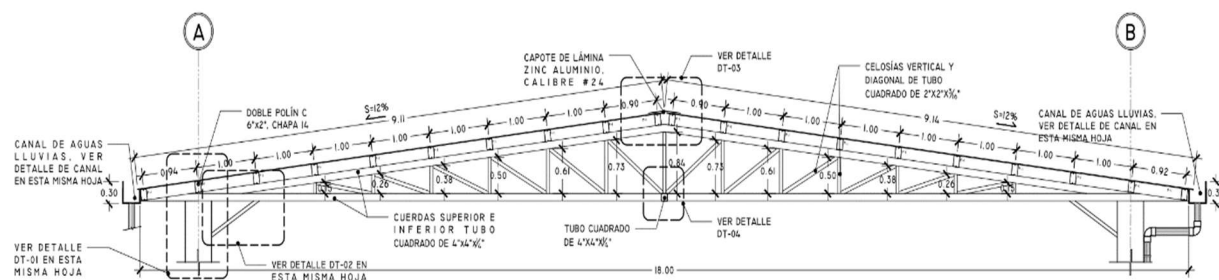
Tijera metálica para apoyo de cubierta de techo. Fuente: Elaboración Propia.
